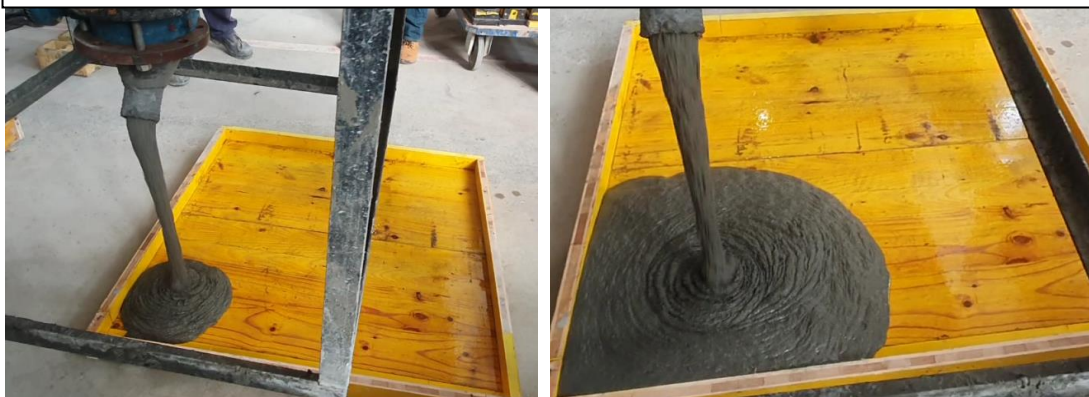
Secuencia de hormigonado para las vigas de 15x15x60 cm
